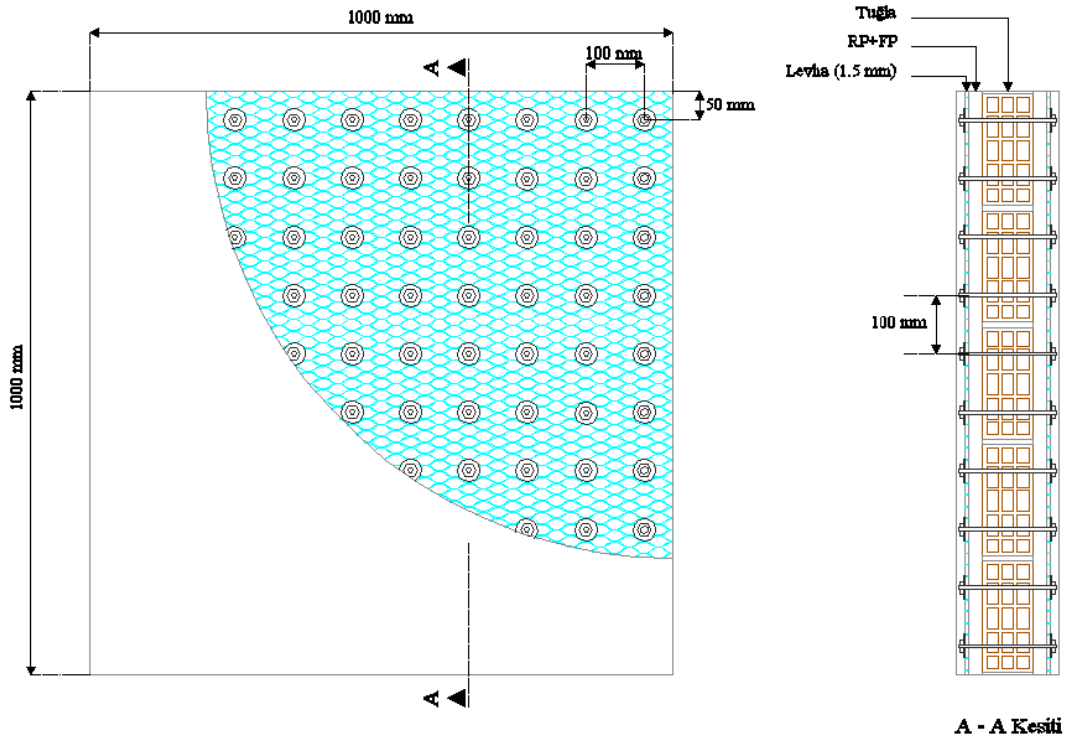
RP3,0-150 deney elemanın boyutları ve güçlendirme detayları
